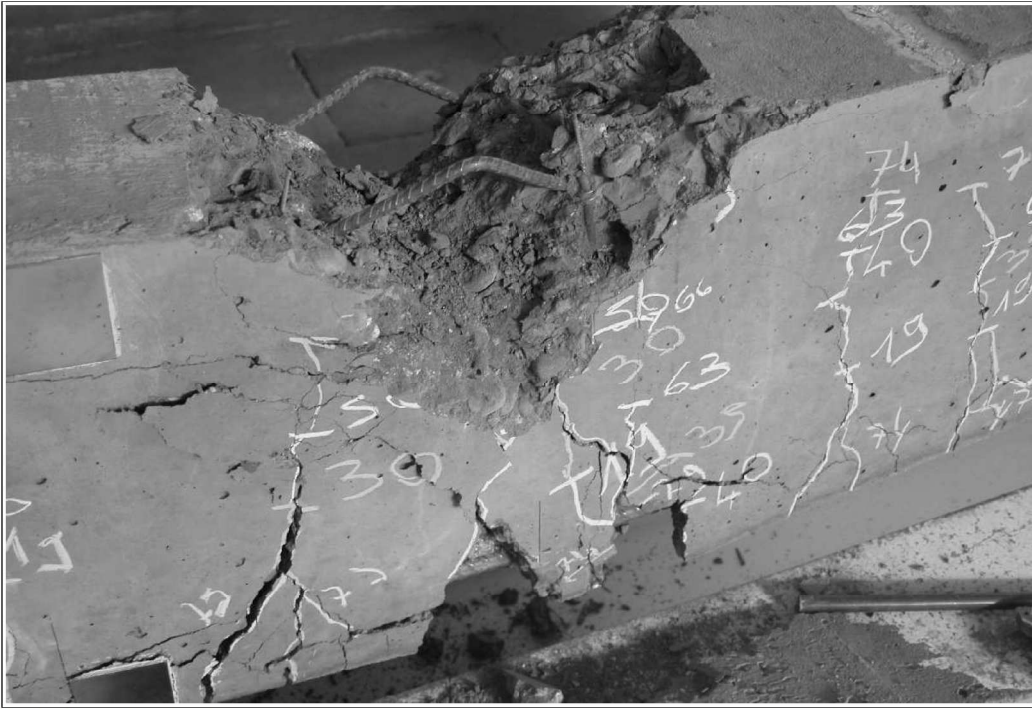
flambement des aciers de montage en zone comprimée d'une poutre fléchée
